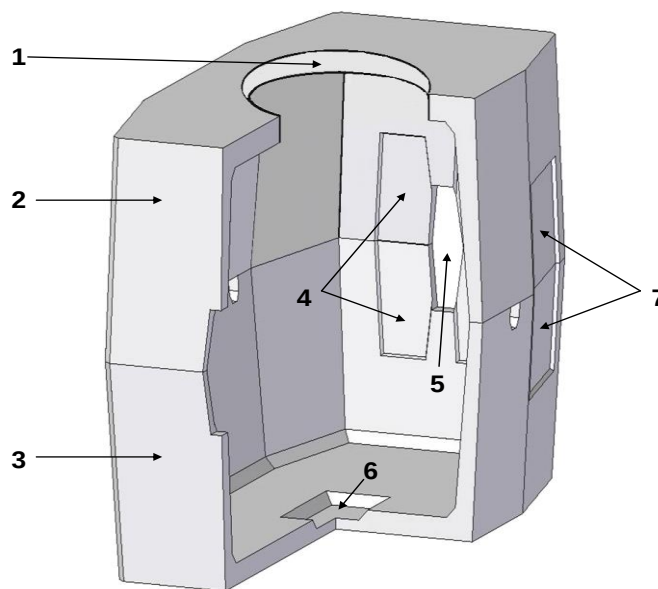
Колодец «ККСр-3-80» в сборе, внешний вид и детали элементов колодца:
